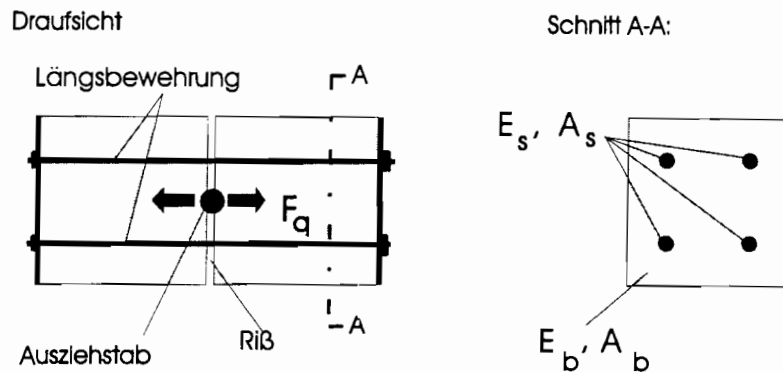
Quersteifigkeit durch Betondeckung und Bewehrung.
